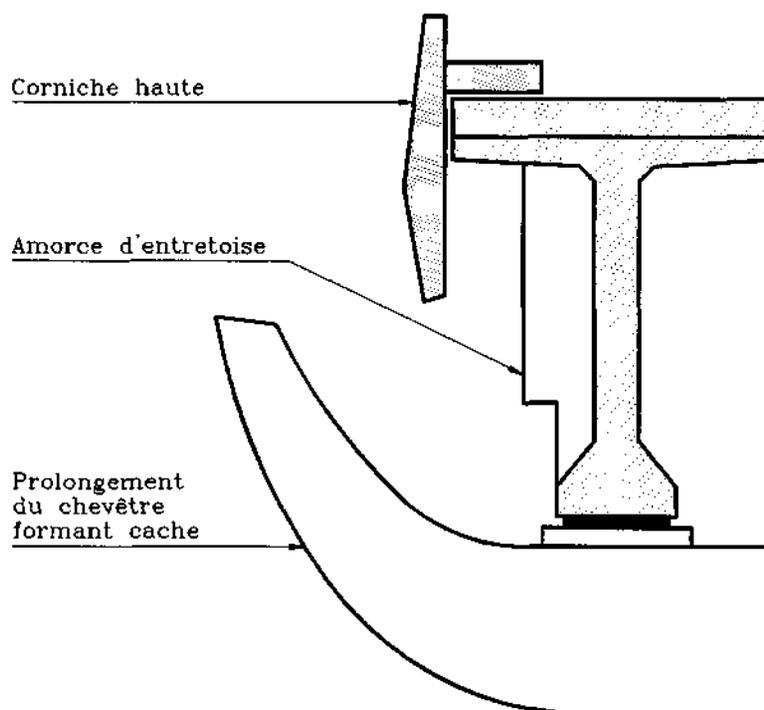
Muret cache dans le prolongement du chevêtre d'appui
